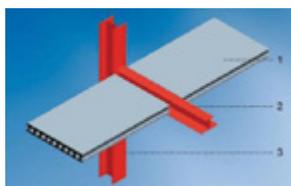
Пустотные плиты опираются на нижний пояс стальной балки. 1 – сборная железобетонная плита, 2 – стальная балка, 3 – стальная колонна.
